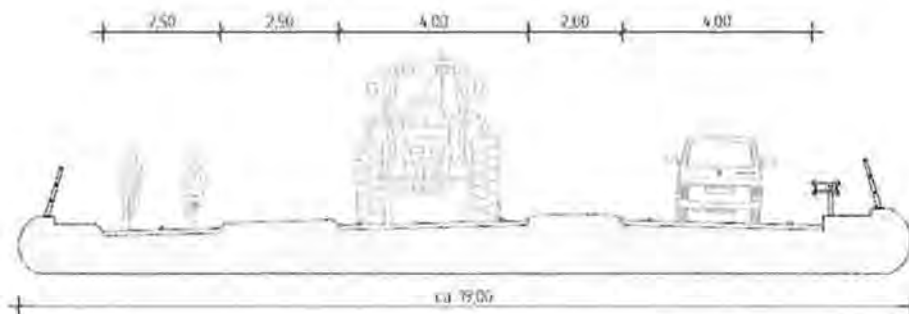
Principe dwarsprofiel parallelwegen ter plaatse van een tunnel (open gedeelte)
